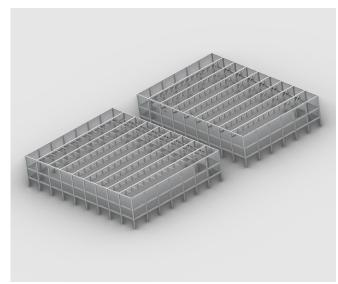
Konstruktionsvarianten für Sporthalle
